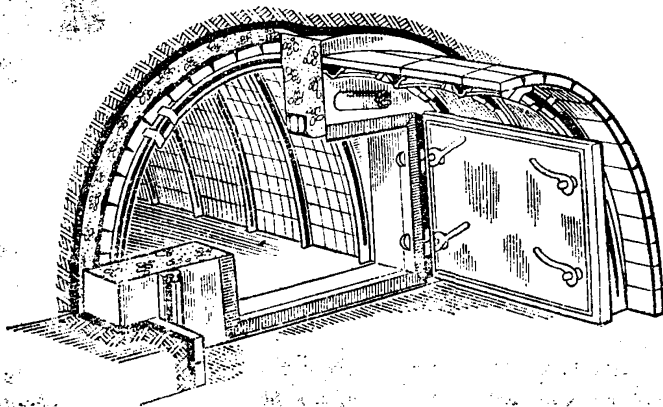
Железобетонная защитно-герметическая перемычка с защитно-герметической дверью
